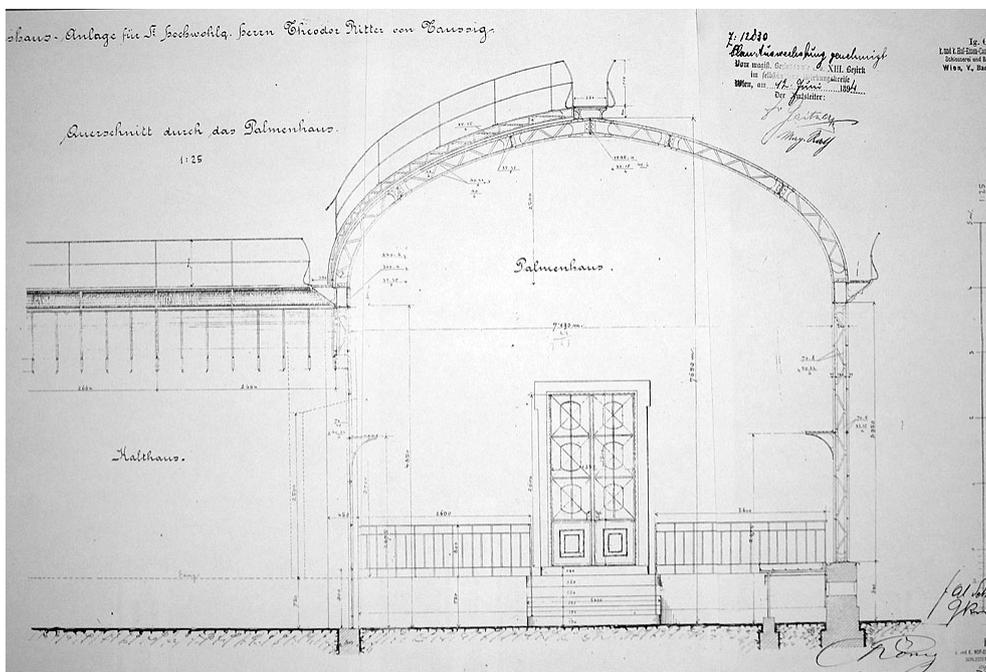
Villa Taussig. Querschnitt durch das Palmenhaus. 1894. Einreichplan.
